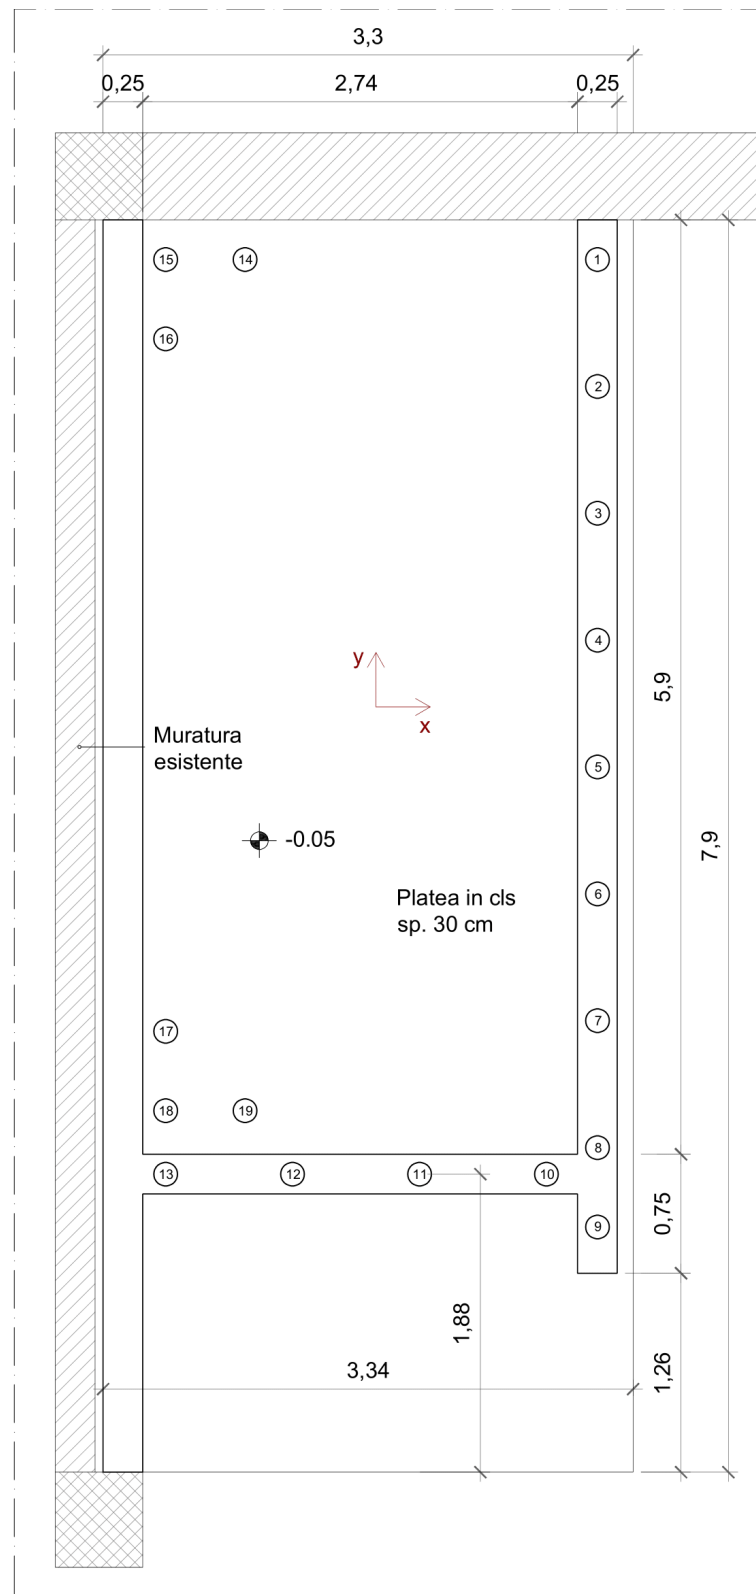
Disposizione planimetrica dei micropali - scala A.
